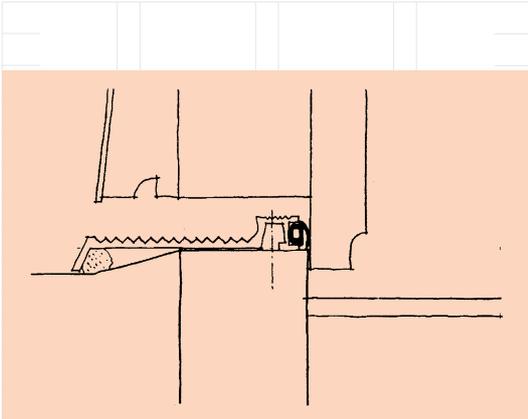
Türschwelen mit Dichtungsprofilen, auch für den nachträglichen Einbau
